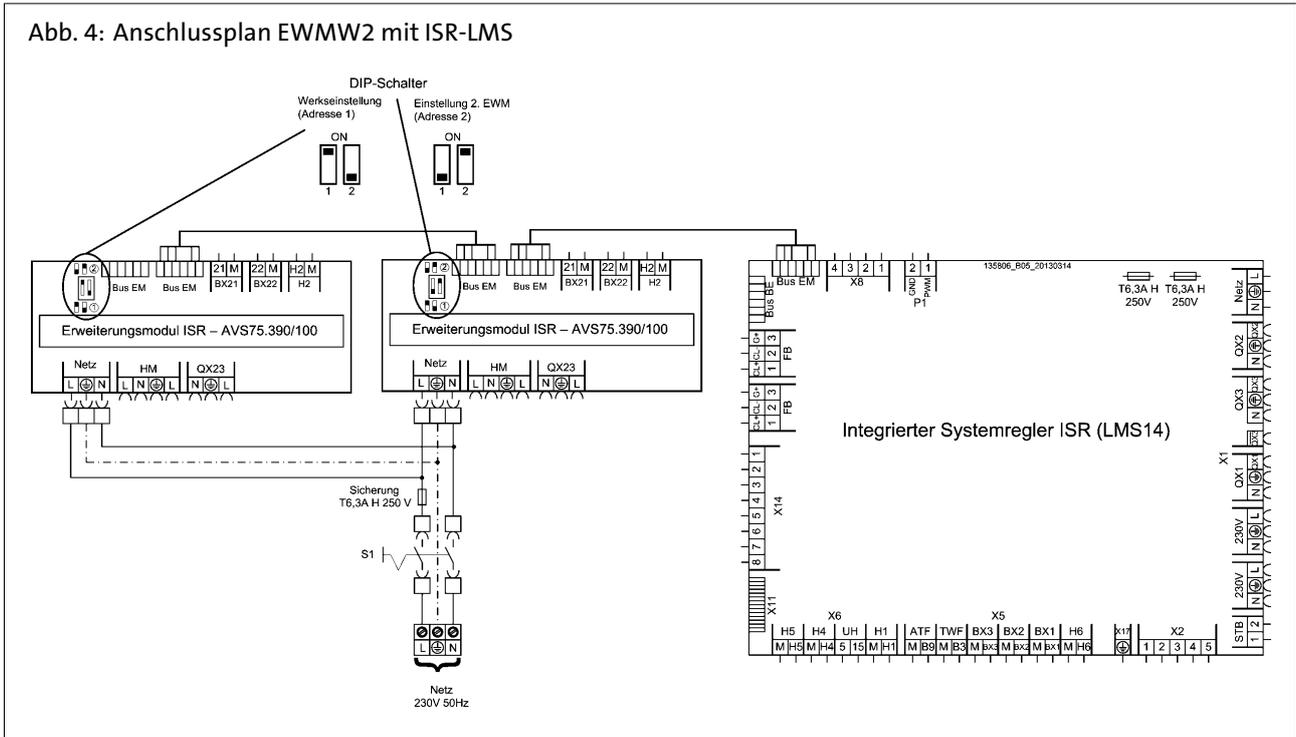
Anschlussplan EMMW2 mit ISR-LMS
